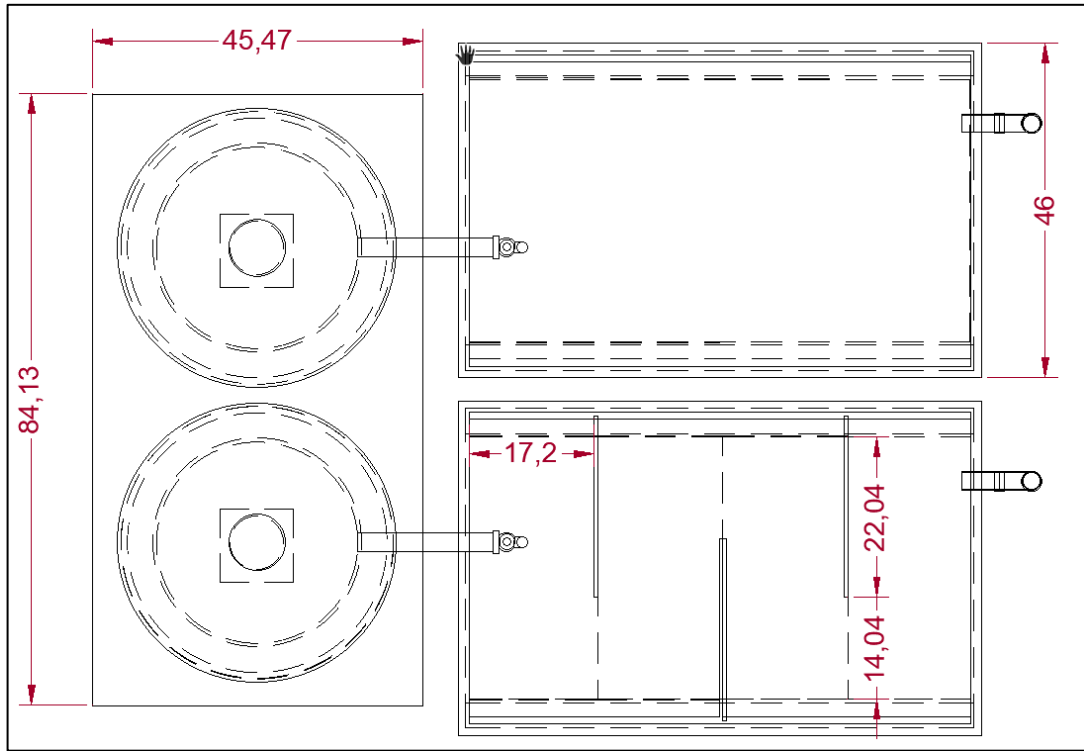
Vista en planta de los humedales artificiales subsuperficial de flujo horizontal
